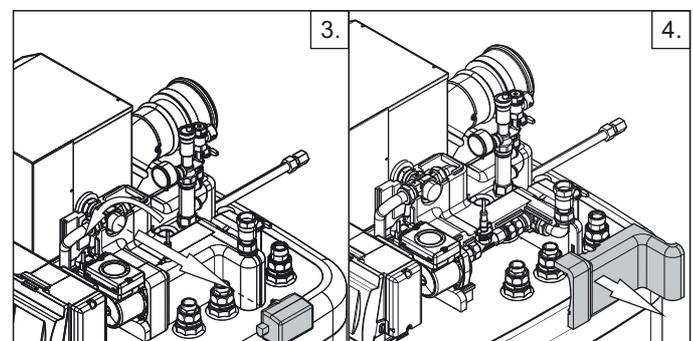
Ventilantrieb und Wärmedämmung ausbauen - 3.+ 4.
